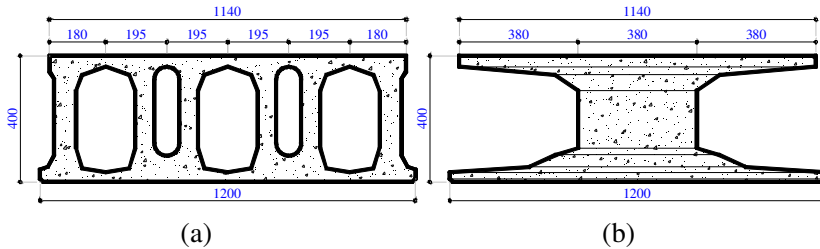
(a) Seção transversal da laje alveolar; (b) Seção transversal de análise (Dimensões em mm)
